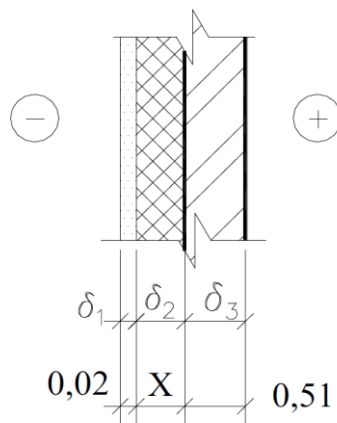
Конструкція зовнішньої стіни цивільної будівлі
